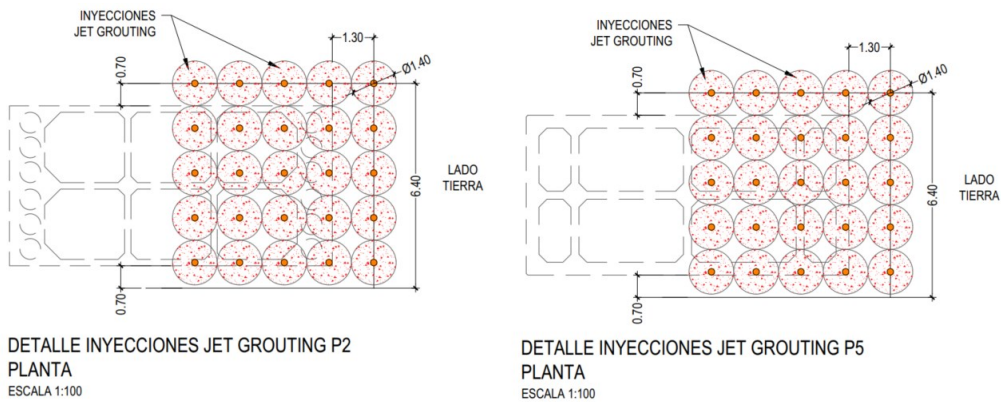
Planta de inyecciones en pila P2 y P5. Área de 6 x 6.4 m.
